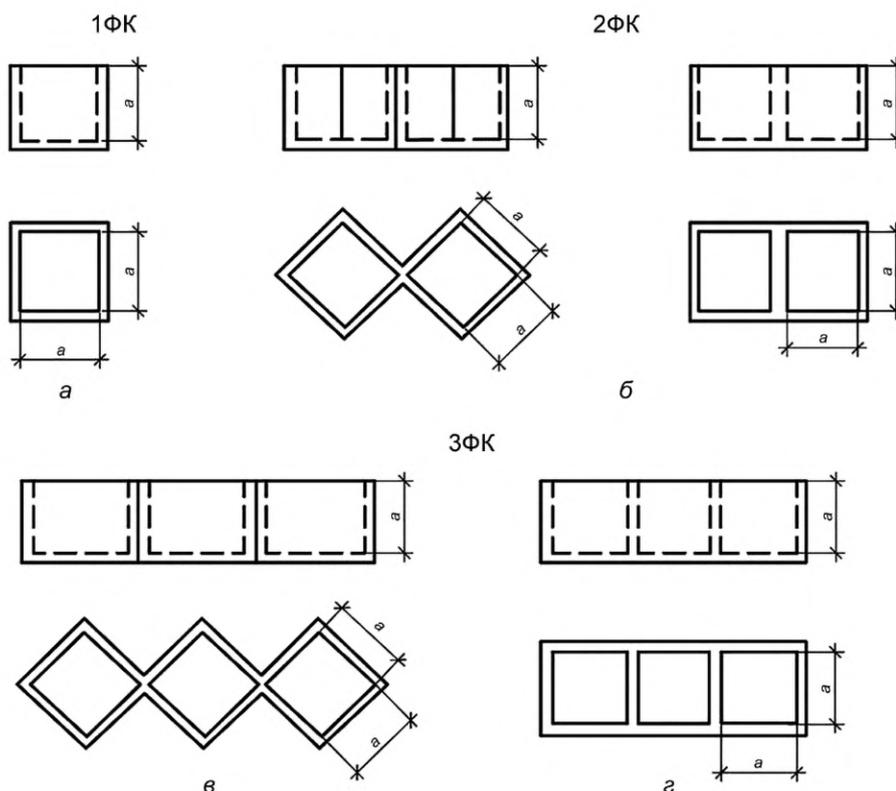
Формы для изготовления образцов в виде куба. Типы ФК
